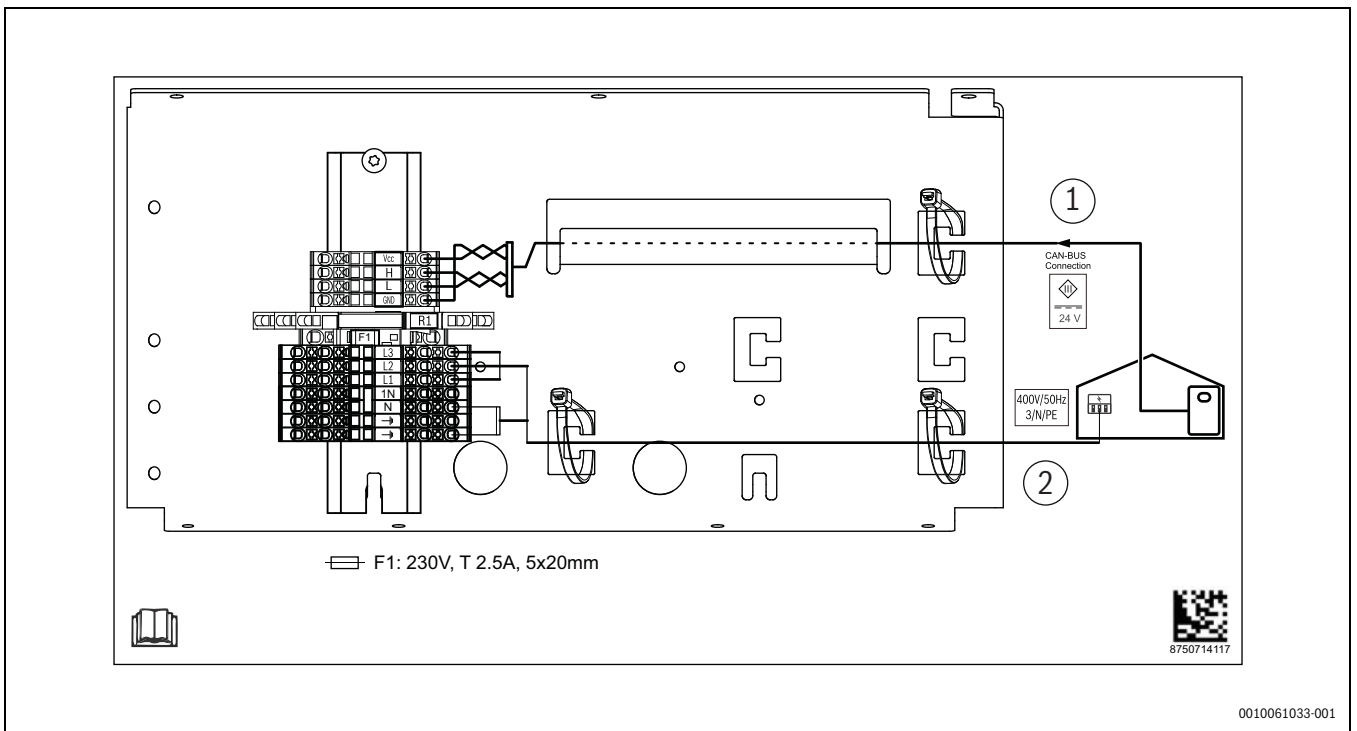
Anschlussklemmen im Anschlussbereich der Installation
